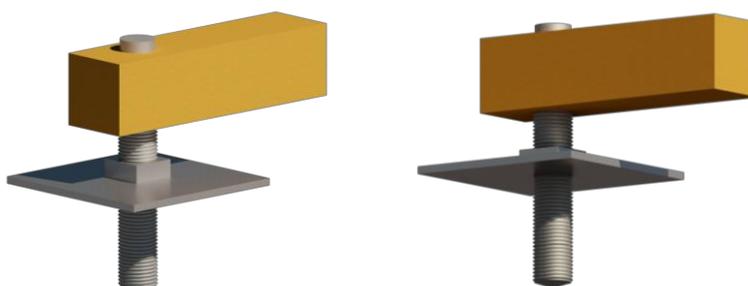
Proposta de fundação dos módulos – Fonte: elaborado pelos autores (2018)
